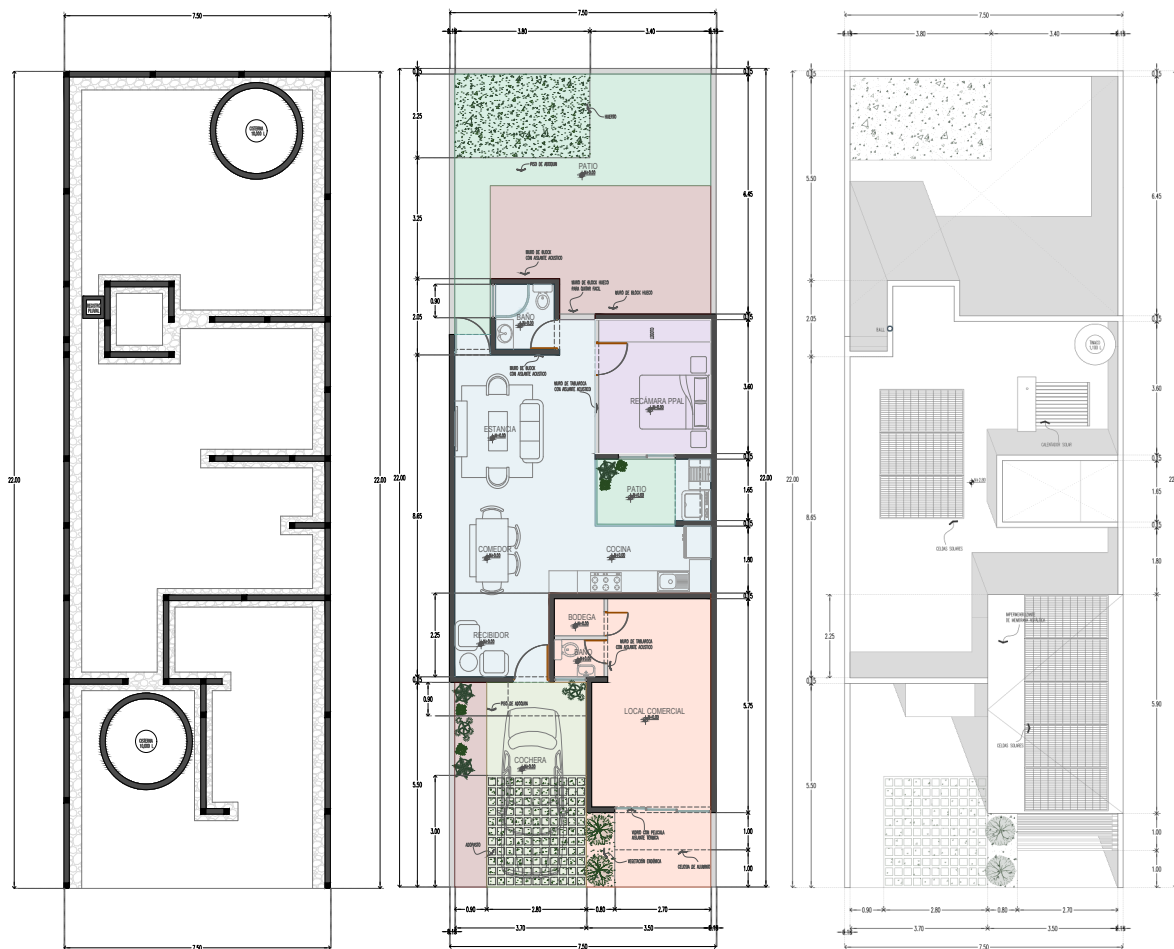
Planta de cimentación, planta baja y planta alta de etapa 1.
